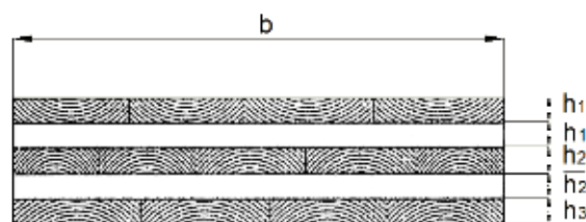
Coupe transversale d'un panneau 5 plis.
